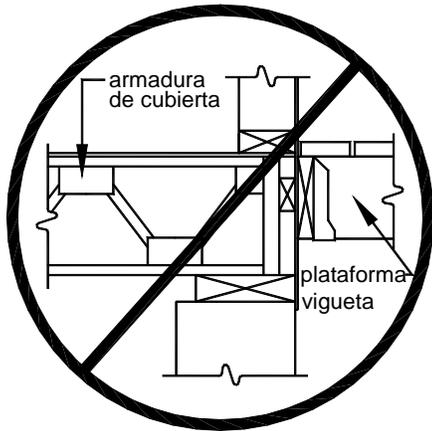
SIN UNIÓN CON LA ARMADURA DE CUBIERTA
